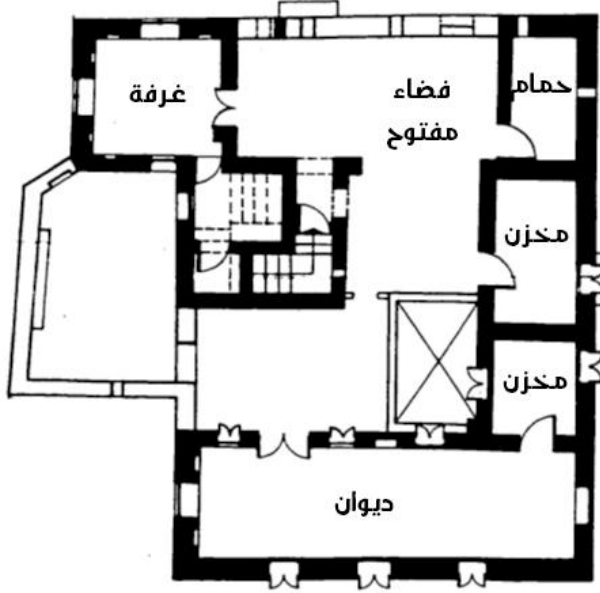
مسقط الطابق الأرضي لبيت المحفدي. المصدر⁽²¹⁾
